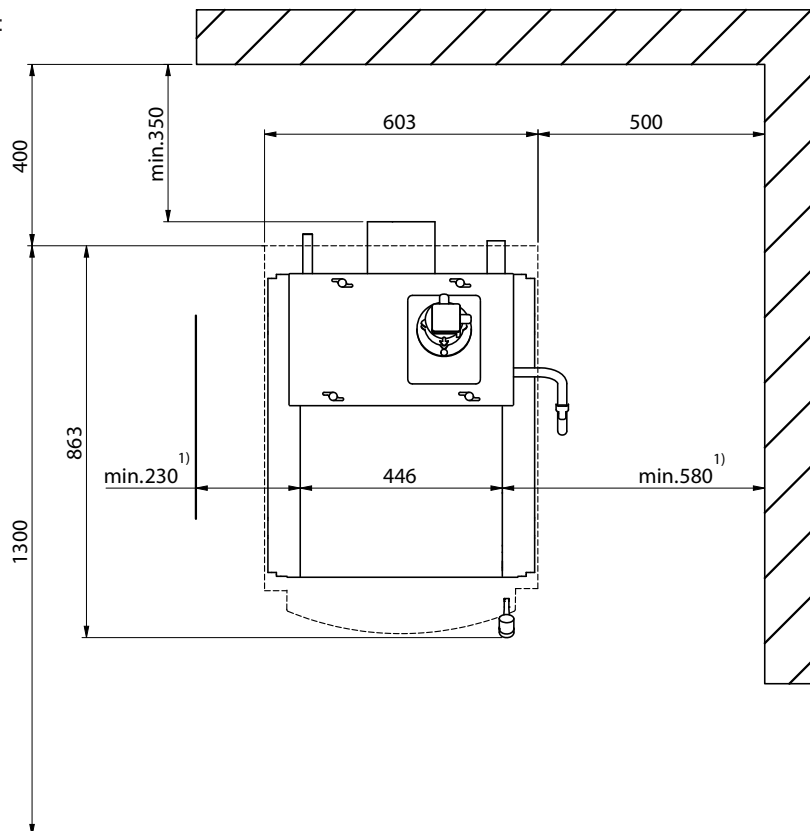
EasyWIN Klassik/Premium – Vista dall'alto
